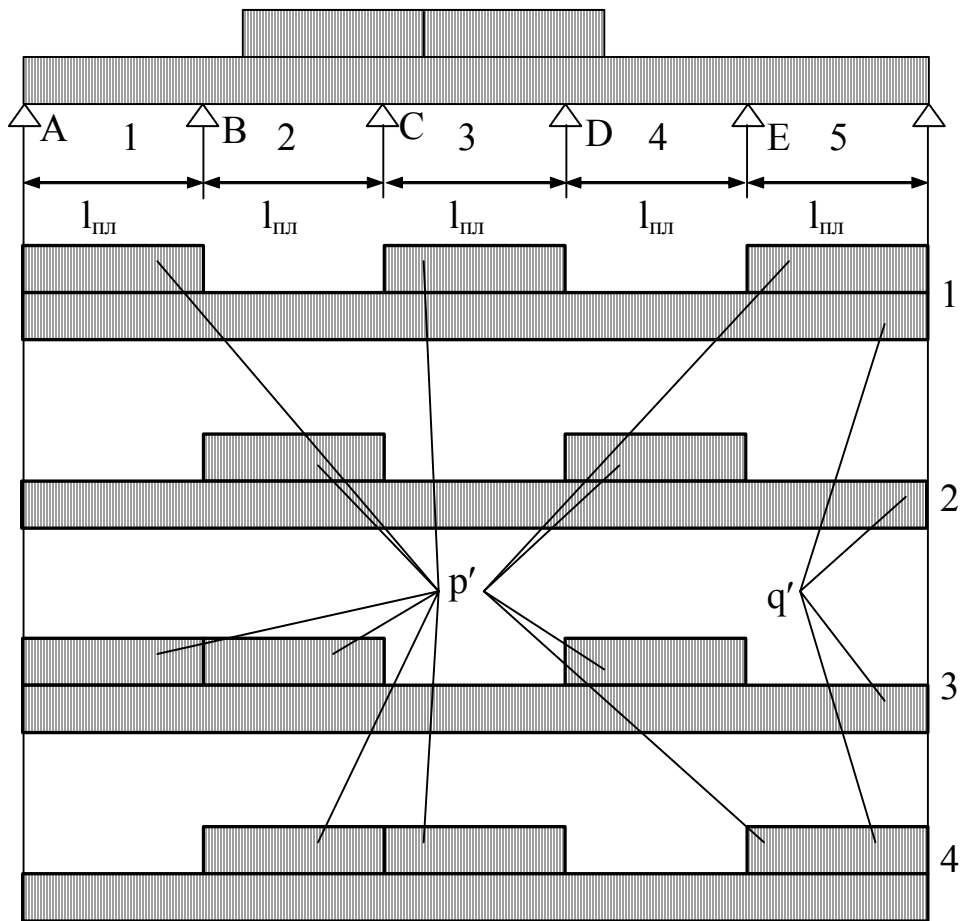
Расчетная схема пятипролетной балочной плиты, схема невыгоднейшего нагружения постоянной и временной нагрузкой.
